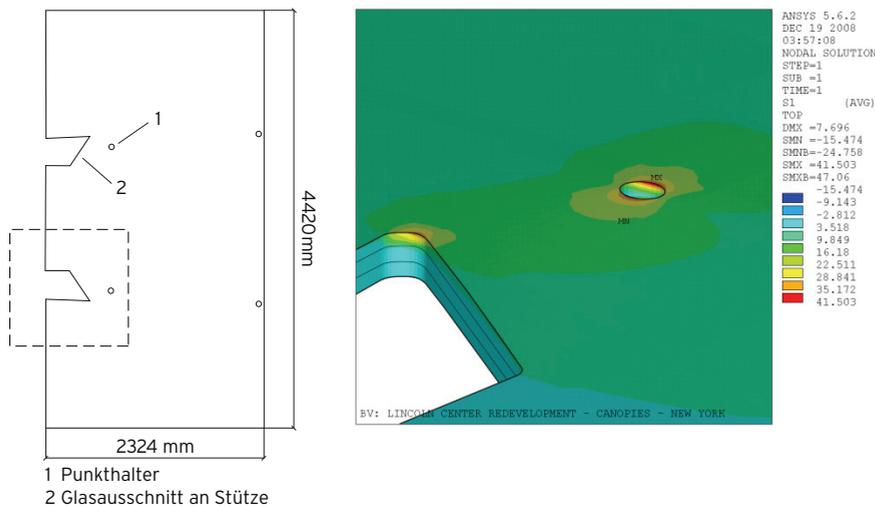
Aufsicht Glasscheibe der Dachfläche mit vier Punkthaltern / Detail Glasscheibe – Rechenmodell Spannungsverteilung (Bild: LFK Ingenieure)
